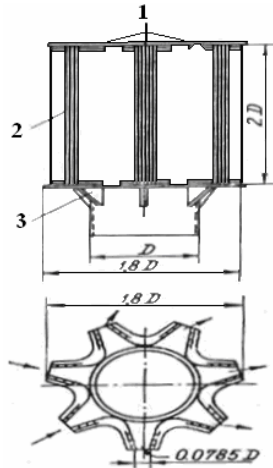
3.17. Зіркоподібний дефлектор: 1 - ковпак; 2 - корпус; 3 - косинка для кріплення корпусу до труби.
